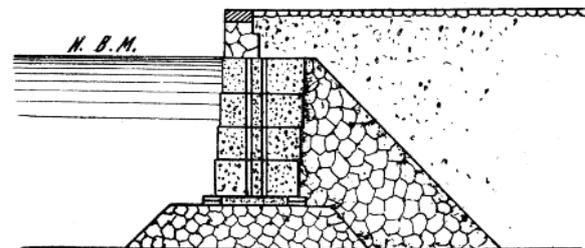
ª.—Puerto de Málaga. Sección del muelle.
